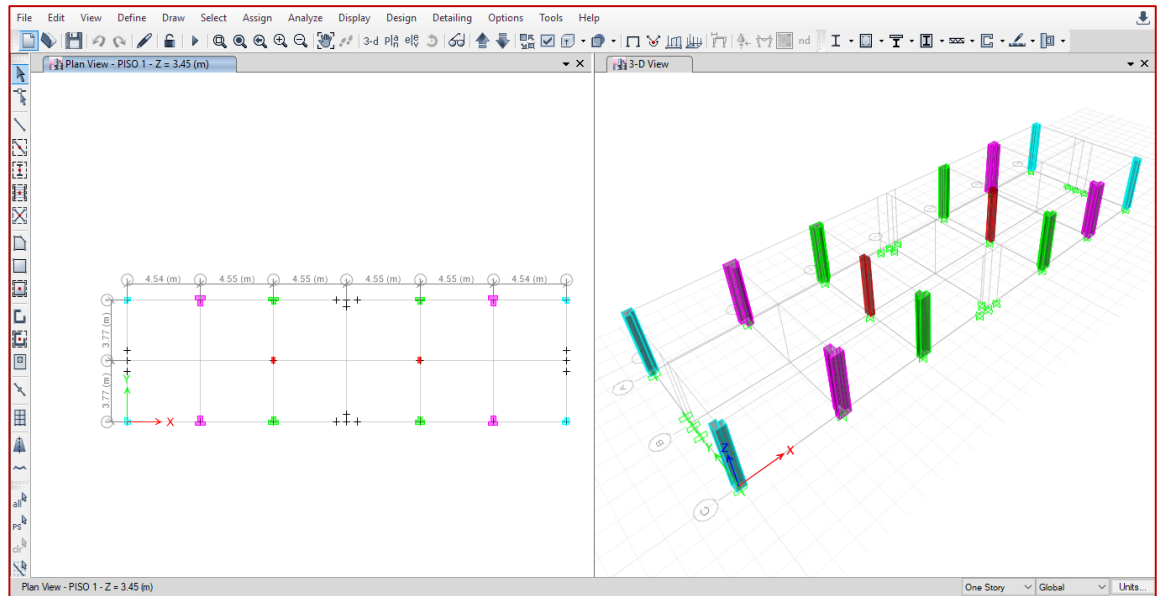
Dibujo de Columnas en el Software Etabs V.16.2.1
